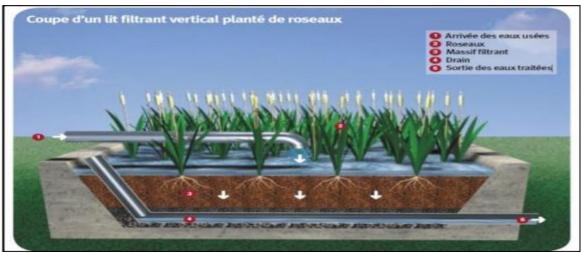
Une coupe d'un lit filtrant vertical planté de réseaux d'assainissement.
